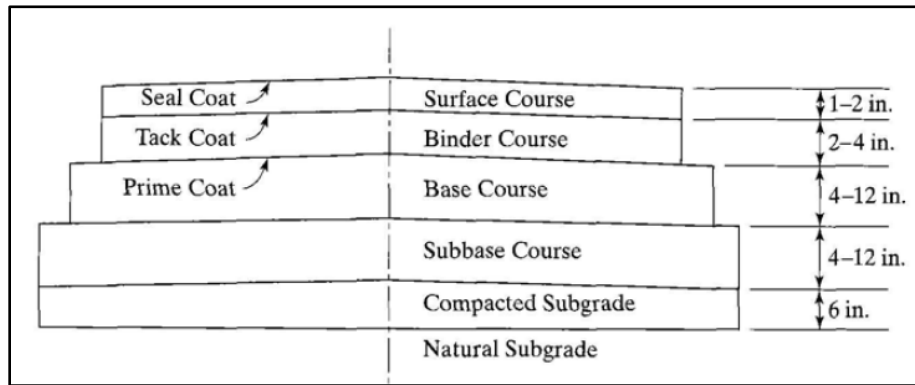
Sección típica de un pavimento de concreto asfáltico
